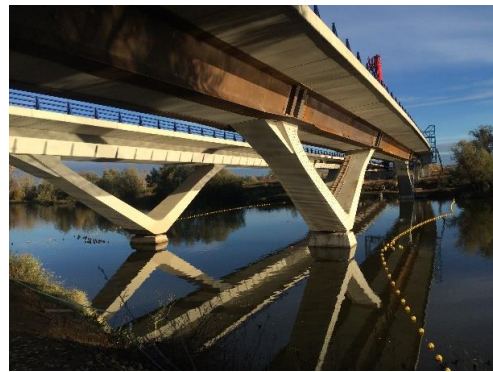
Vista general de la viga pretensada reforzada en la zona de paso de pila inclinada.
